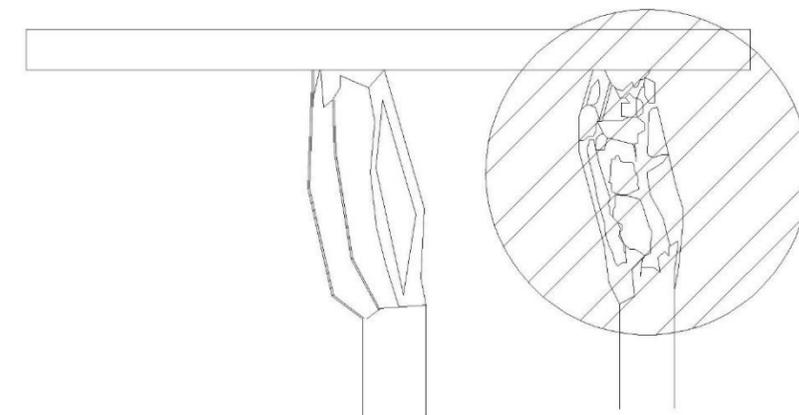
Columna corta. Fuente: equipo de trabajo
